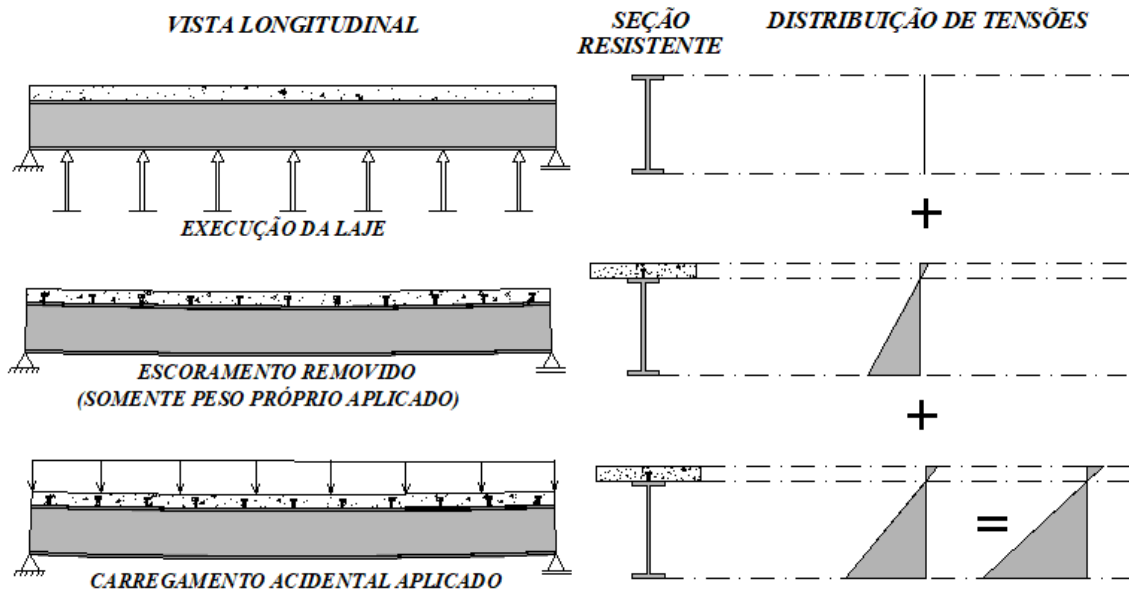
Estruturas mistas escoradas – Fonte: Adaptado Fabrizzi (2007).
